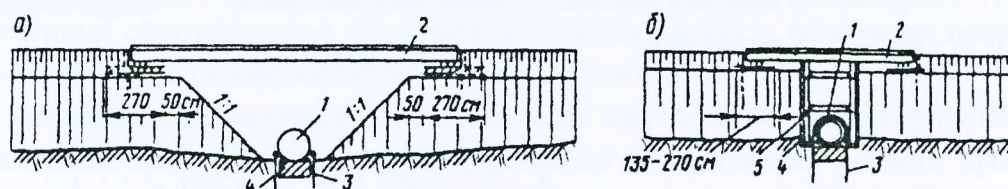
Устройство трубы в насыпи открытым способом (а) и в прорези (б): 1 – сооружаемая труба; 2 – инвентарное пролетное строение; 3 – шпунт; 4 – фундамент трубы; 5 – распорка.
